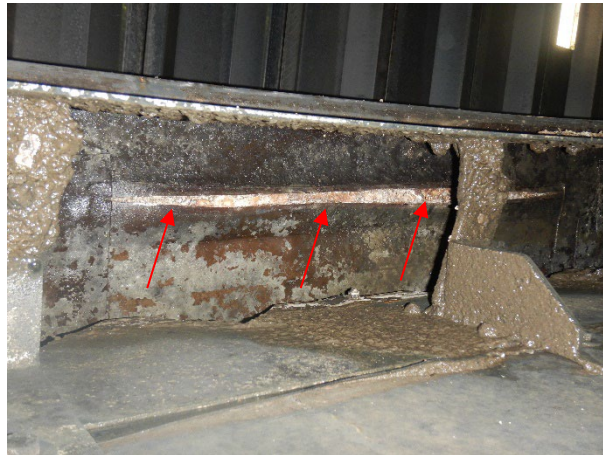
Lining onderzijde omlooprand gescheurd/open, beton sterk aangetast.
